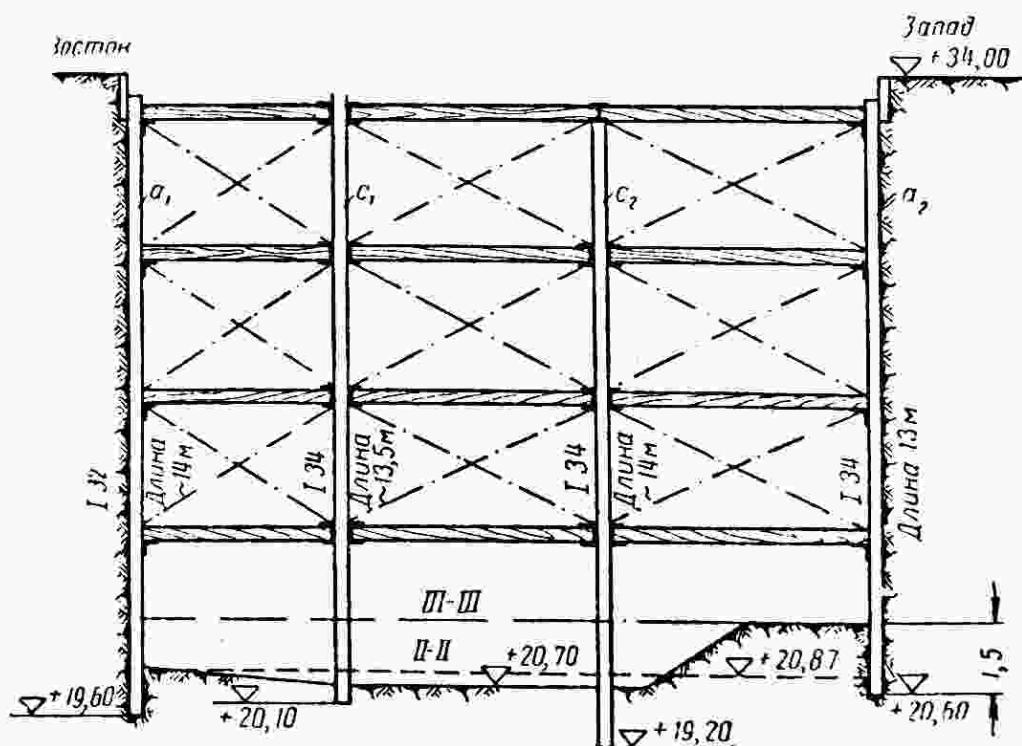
Поперечный разрез крепления котлована Берлинской подземной железной дороги
